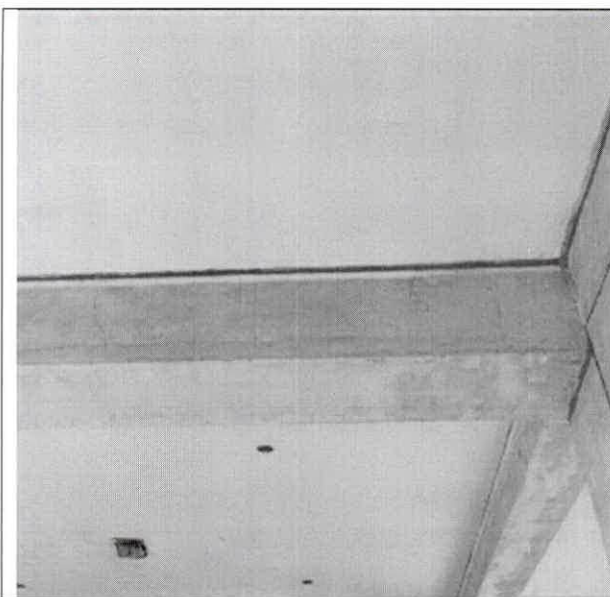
Vista interna de la viga del sector E2, se observa fisuras en las vigas peraltadas.
